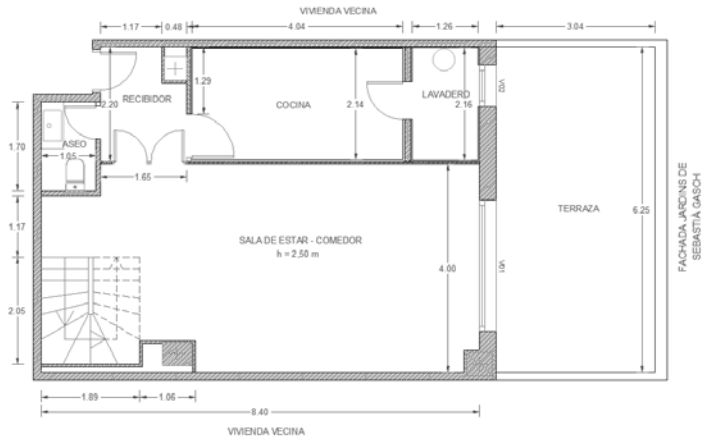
Plano estado actual Planta Baja. Fuente propia
